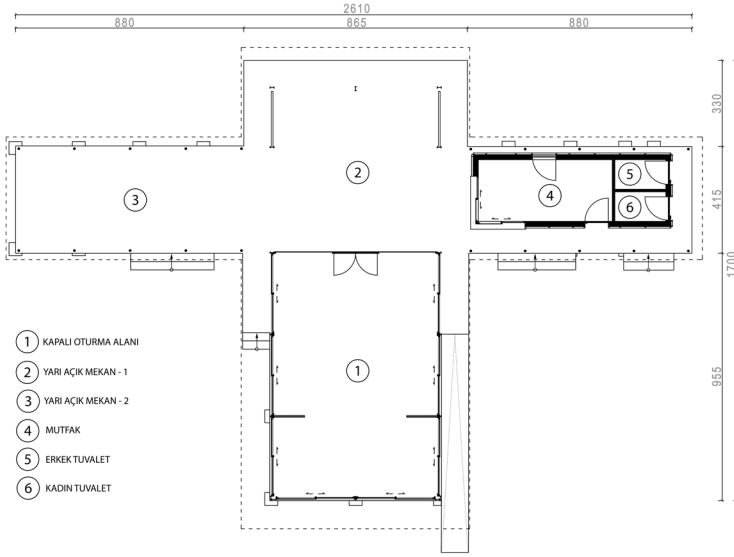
Samsun Üniversitesi Ballica Kampüsü Kantini Vaziyet Planı
